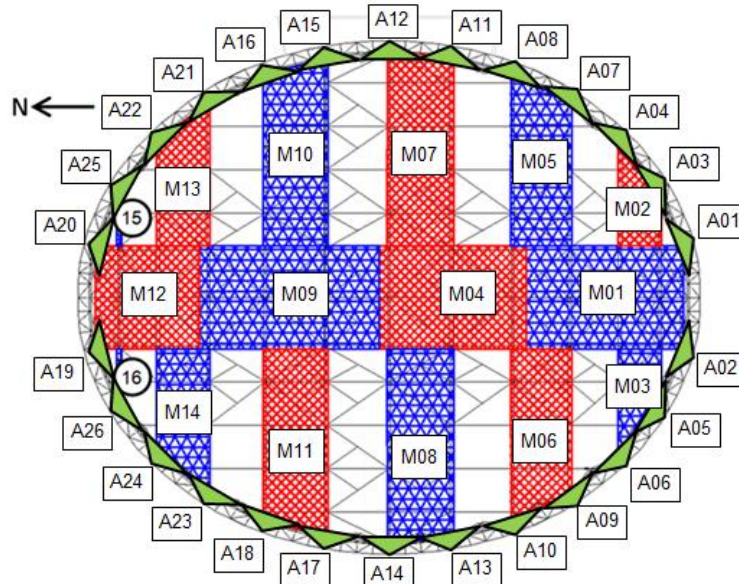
Módulos pre armados en los cuales se subdividió la estructura para su montaje
